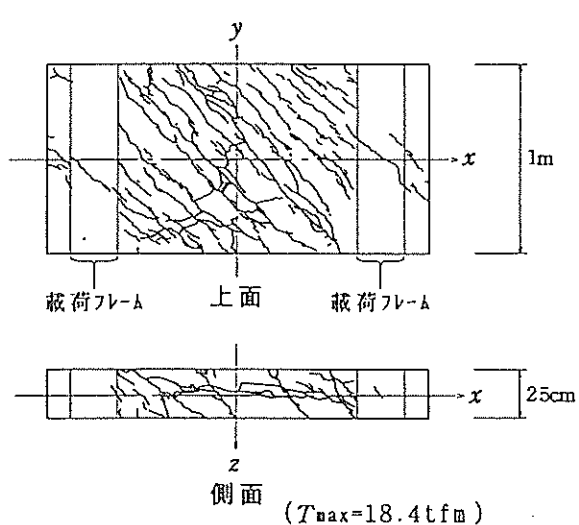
供試体 RC-19-100のひび割れ発生位置
